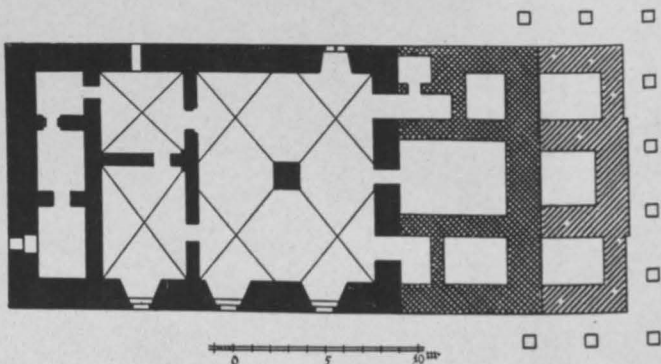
Fürstenwalde. Grundriß des Rathauses. Kellergeschoß.
